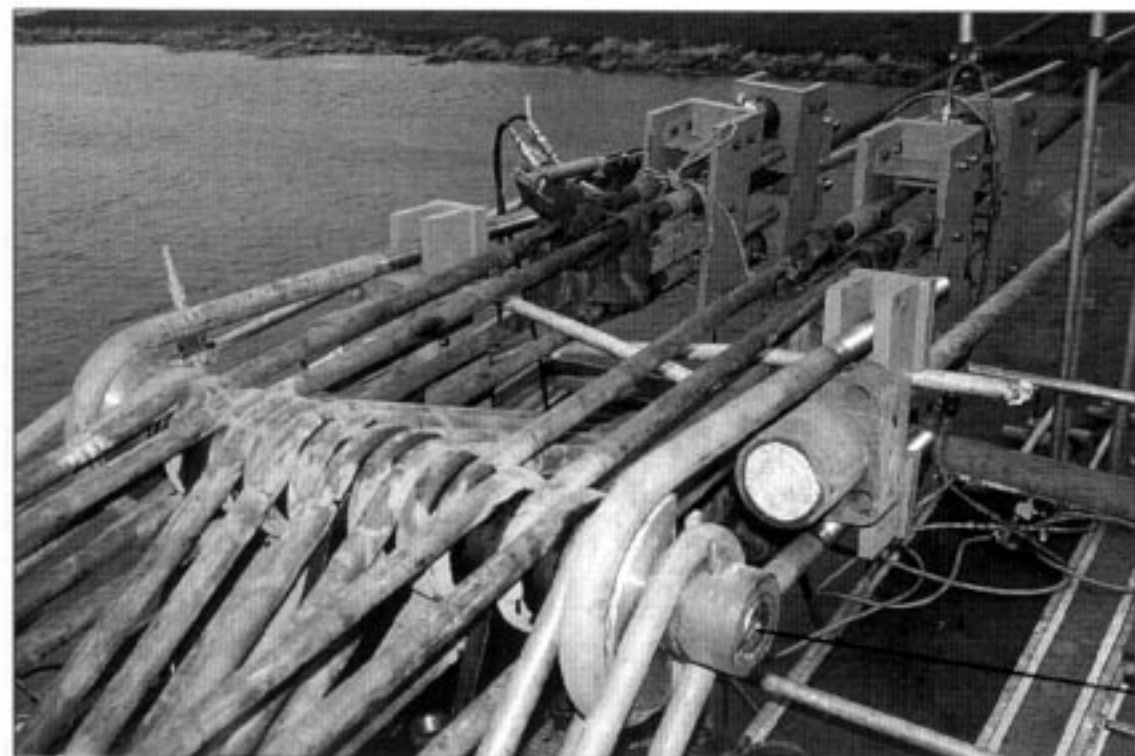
Changement de la suspension - Dispositions adoptées en tête de pylône.
